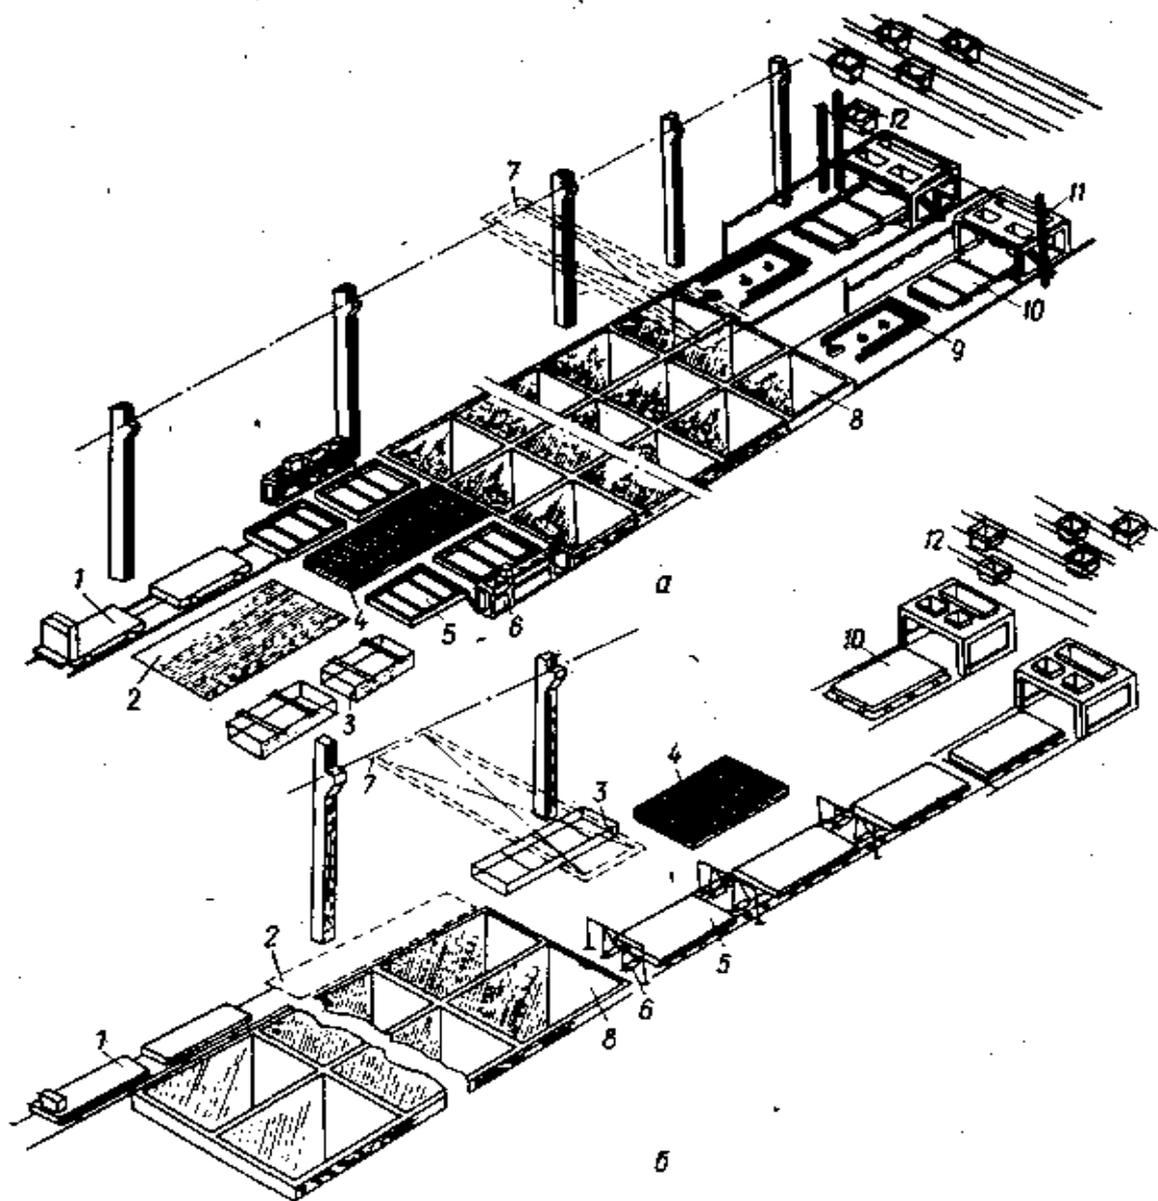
Компонка пролета с двумя формовочными постами по производству бетонных и железобетонных изделий:
